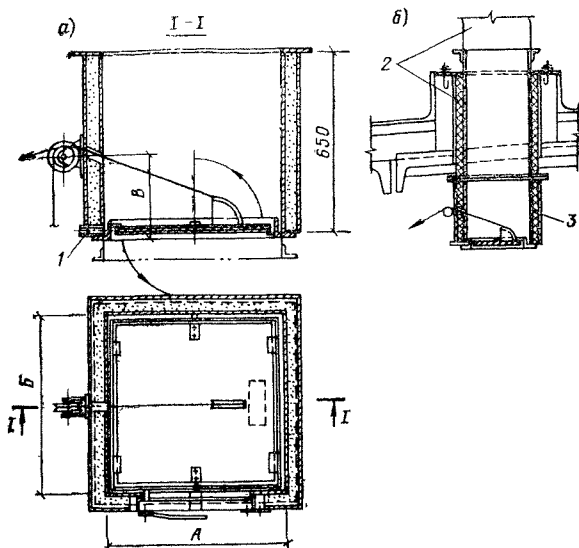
Клапаны перекидные утепленные для вентиляционных шахт
